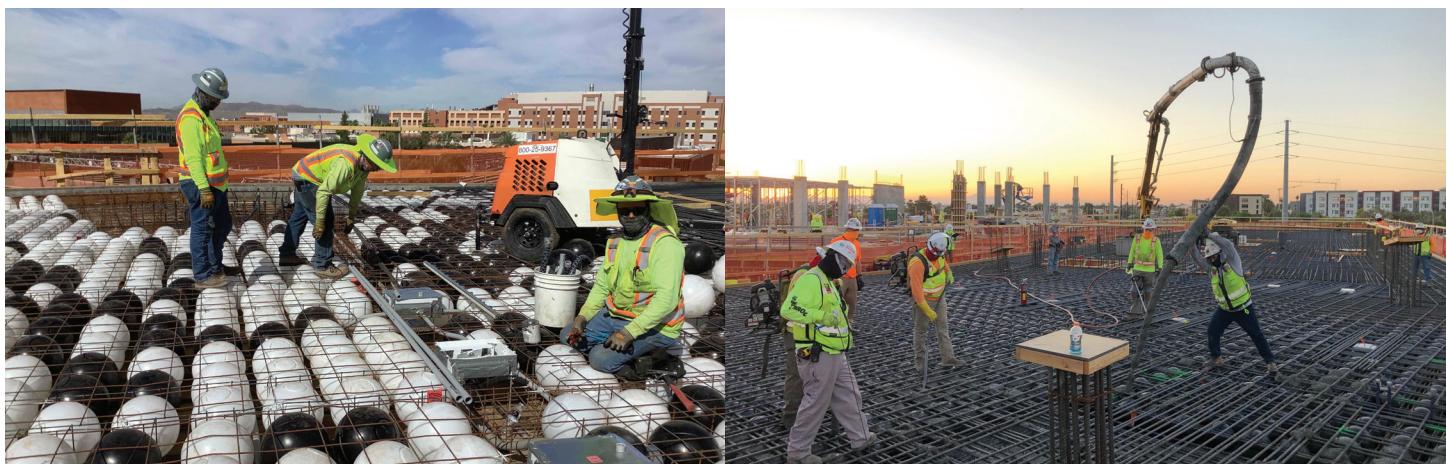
La instalación con cimbra hueca y colocación de concreto para la base elevada (cortesía de McCarthy Building Companies)
